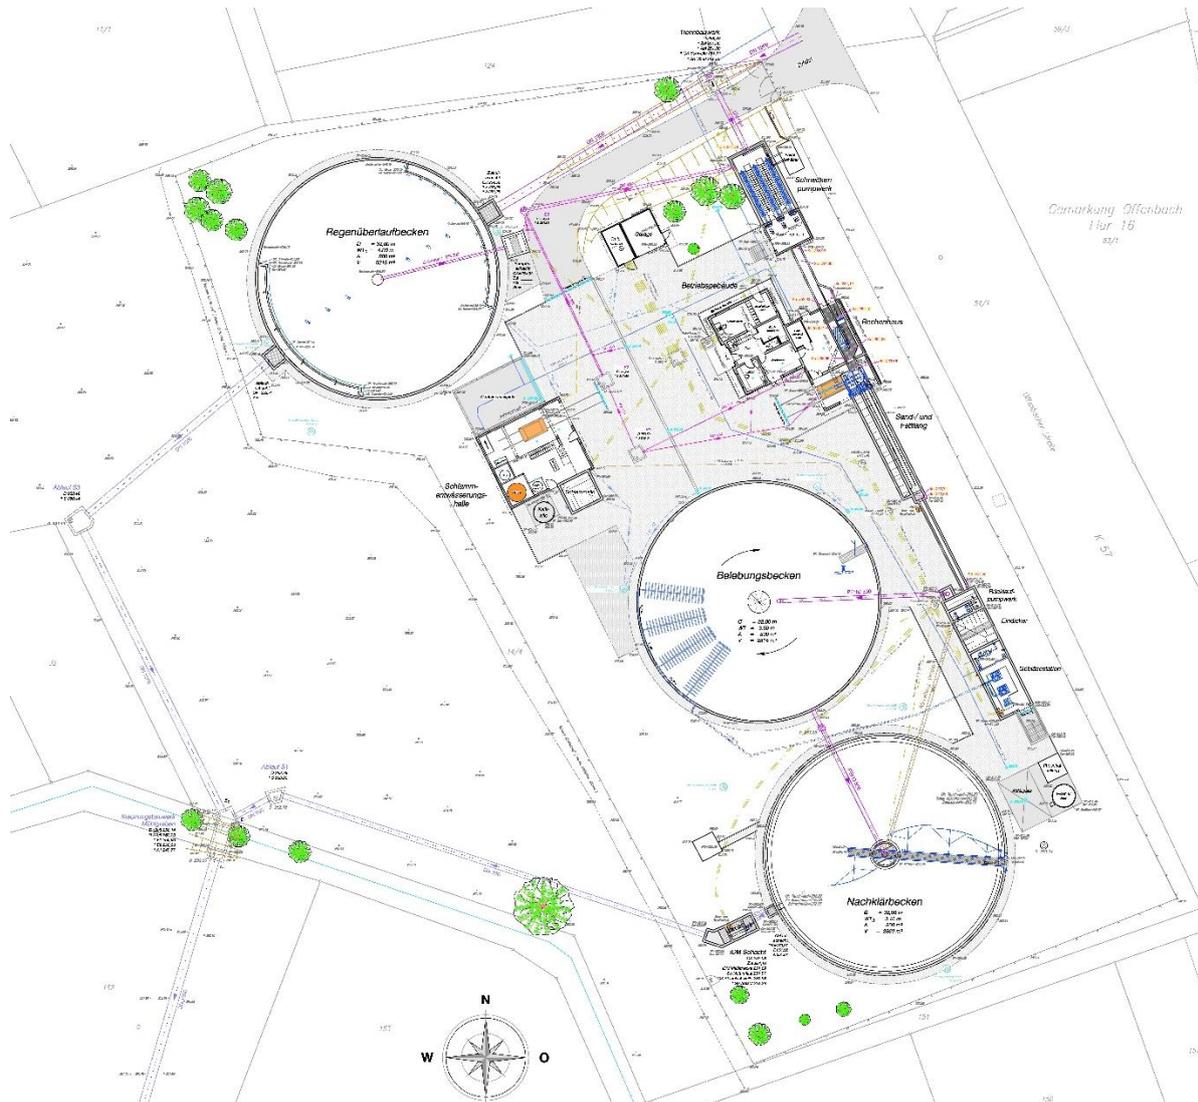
Vorabzug der Vorplanung mit Darstellung des Bestandes, erstellt von PlusPlan Ingenieure GmbH, Stand 20.02.2024
